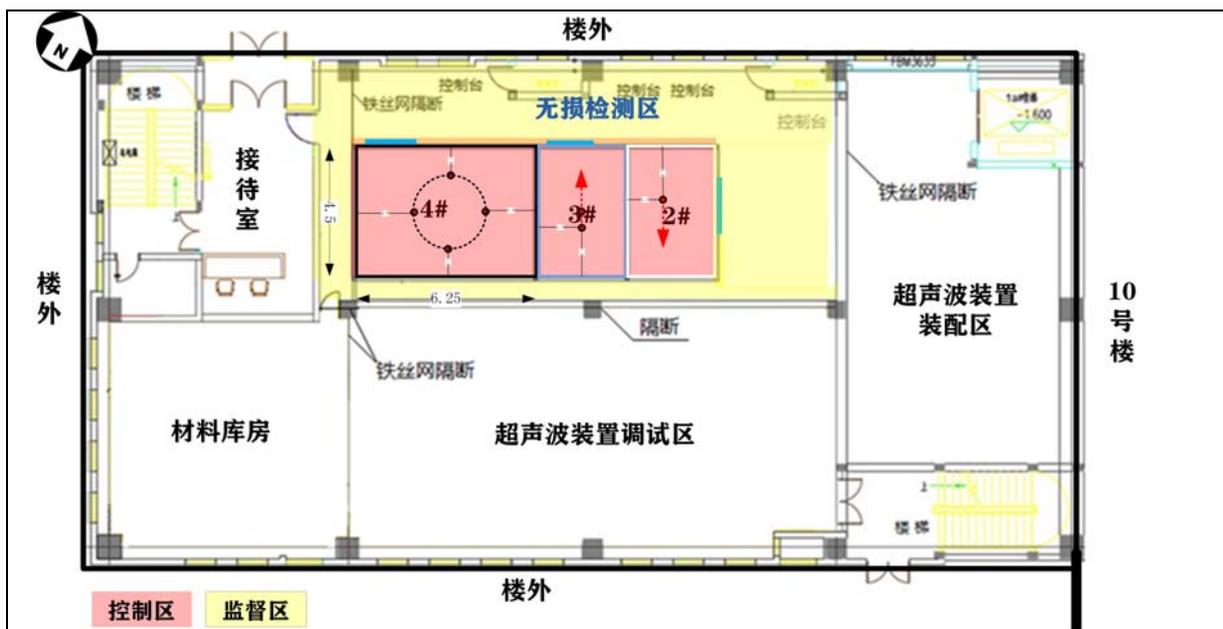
本项目完成后 9 号楼一层平面布置示意图
